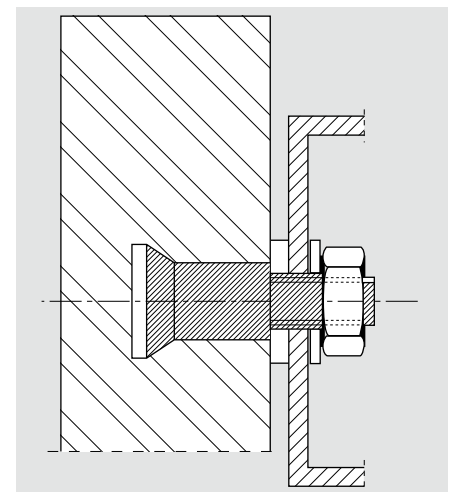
Nicht sichtbare Befestigung in den Bekleidungsplatten mit Hinterschnittdübeln
